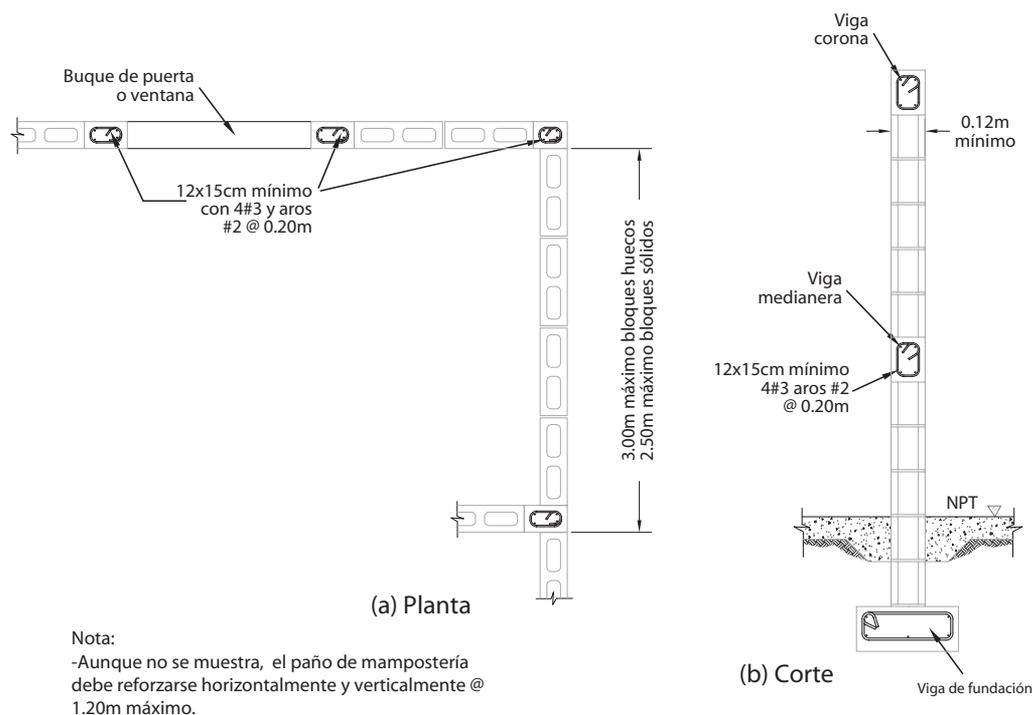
Detalles de marcos rellenos de mampostería.
